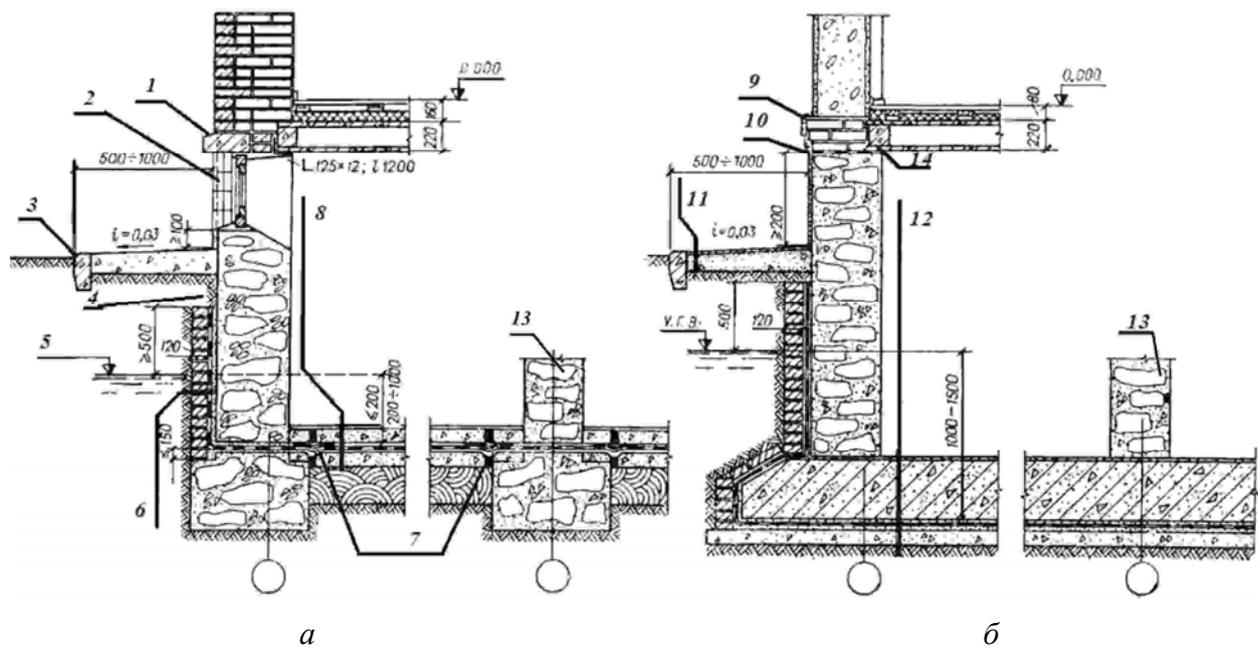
Гидроизоляция подвалов при напоре грунтовых вод до 0,2 м (а) и 1 м и более (б) относительно пола подвала: 1 — поясной ремень; 2 — керамическая плитка на цементном растворе; 3 — бортовой камень; 4 — обмазка горячим битумом выше стенки (два раза); 5 — уровень грунтовых вод; 6 — защитная стенка из кирпича на цементном растворе, вертикальная гидроизоляция мастикой и слой цементно-песчаного раствора; 7 — деформационный шов, заполненный битумом; гидроизоляционный ковер, усиленный стеклотканью; 8 — двойной цементный пол; 9 — кирпич марки 100 на растворе марки 2; 10 — цементная штукатурка; 11 — асфальт 30, щебень ≥ 150 ; 12 — цементный пол 20; ж/б плита; толщина по расчету; оклеечная гидроизоляция между защитной и выравнивающей стяжками из цементного раствора; подстилающий слой бетона марки 100 толщиной 100, уплотненный грунт; 13 — внутренняя стена подвала; 14 — 2 слоя толя или гидроизоляция на битумной мастике
